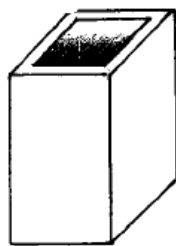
Perfil estructural tipo tubular cuadrado ³⁰
